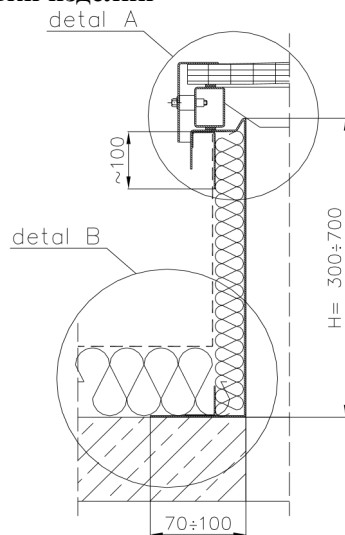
Установка стального основания на крыше (Деталь В) и способ гидроизоляции кровельной мембраной или рубероидом (Деталь А)
